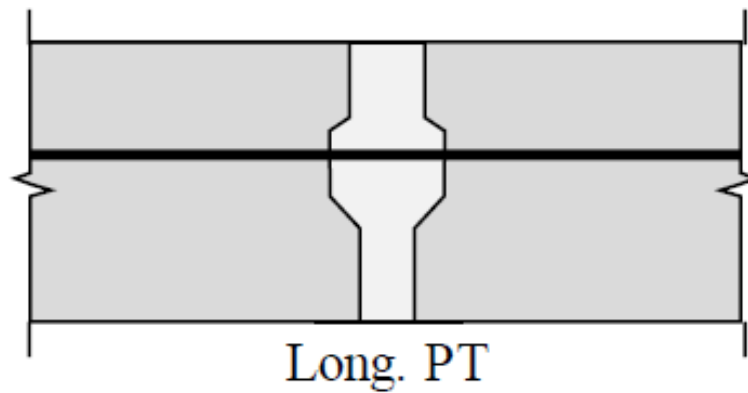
Postensado Longitudinal Paneles Prefabricados. Fuente: ABC UTC Guide to FDPC Decks Panels (2019).
